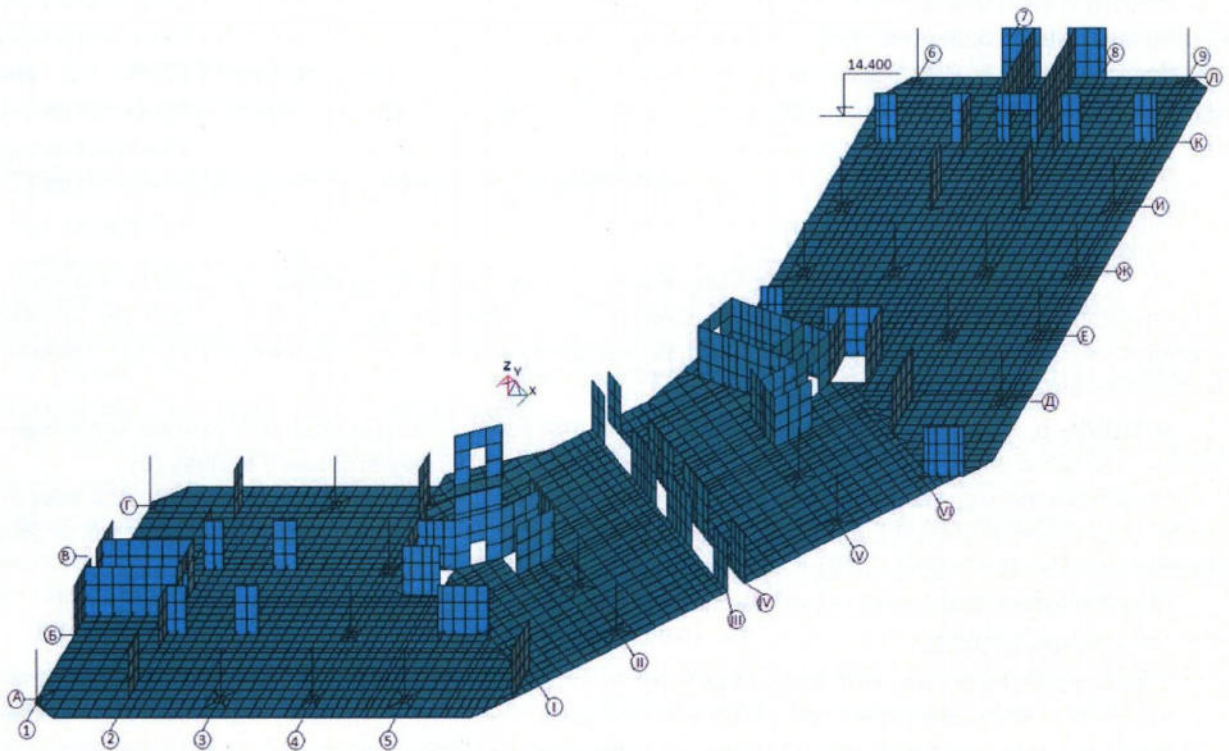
Фрагмент розрахункової моделі. Поверх на позначці 14.400 м
